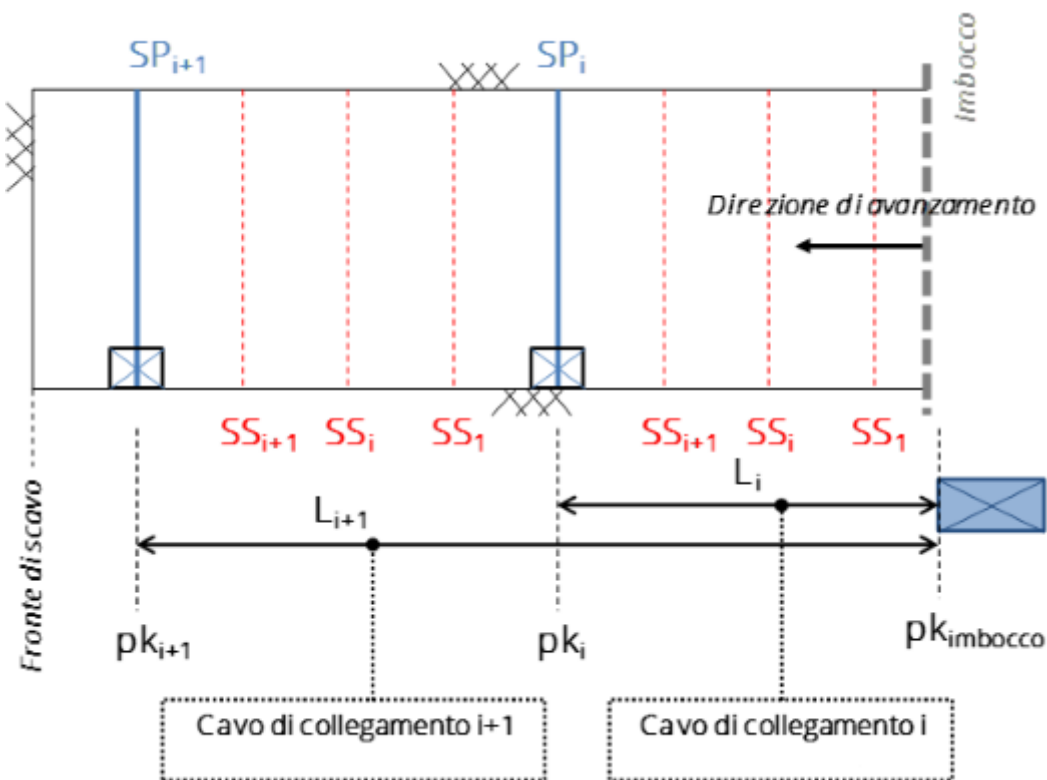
Disposizione dei cavi della rete di collegamento con il sistema di acquisizione dati centralizzato
